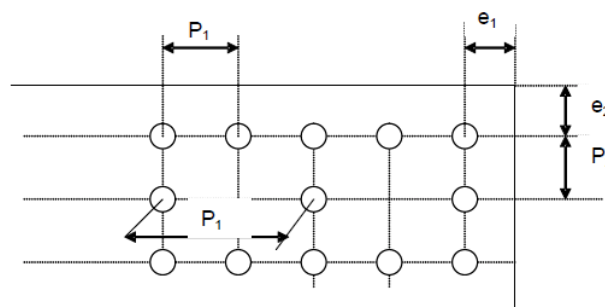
Medidas para determinar la disposición constructiva (EAE)
